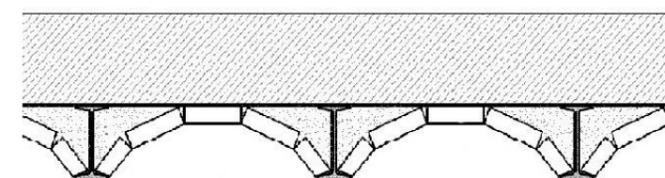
Forjado tipo de vigueta metalica bovedilla de ladrillos a revoltón
